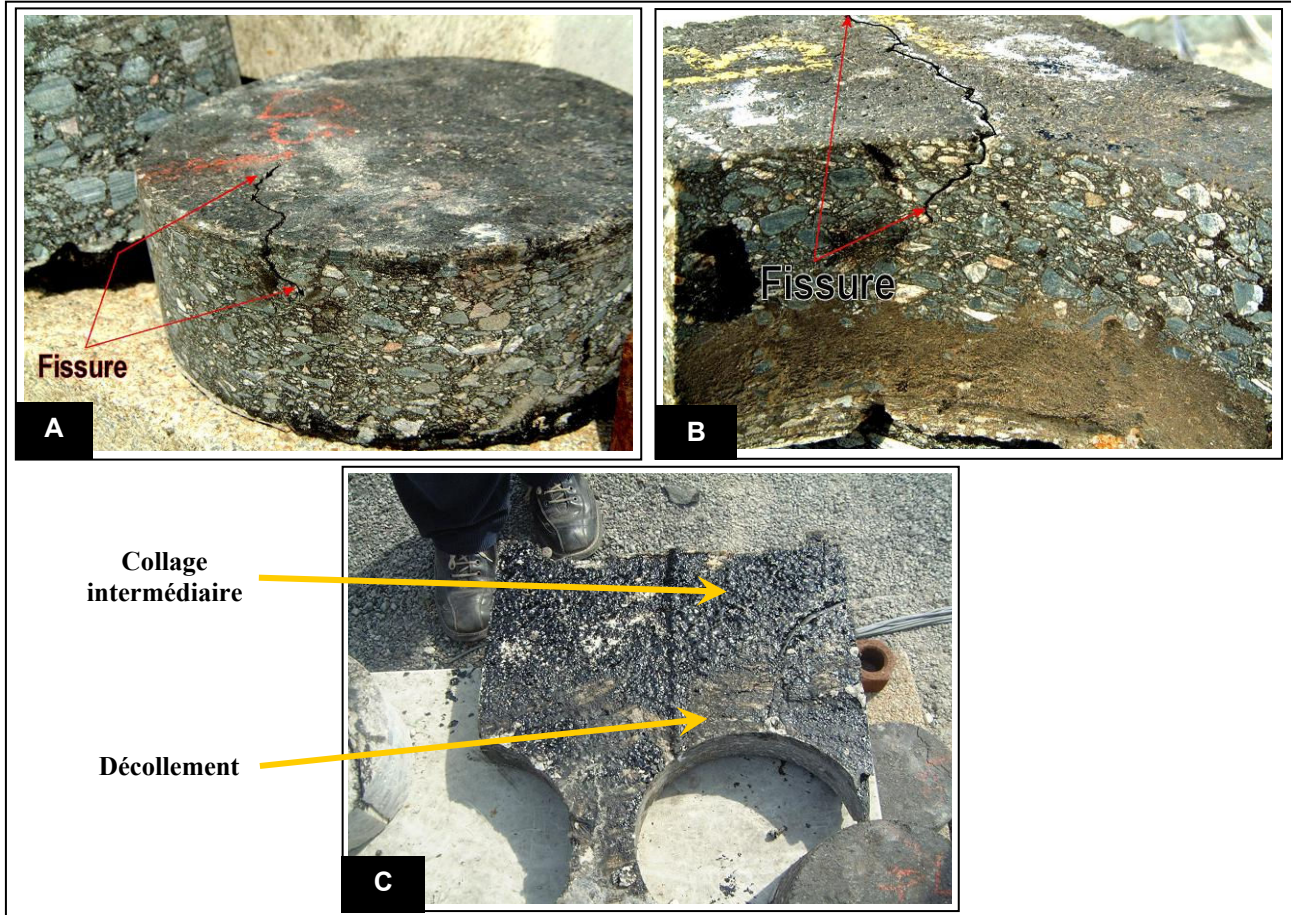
A) Fissuration d'échantillons du Joint N° 3 – B) Fissuration du joint N° 7 – C) Décollement partiel de l'interface dalle / couche de roulement du joint N° 3
